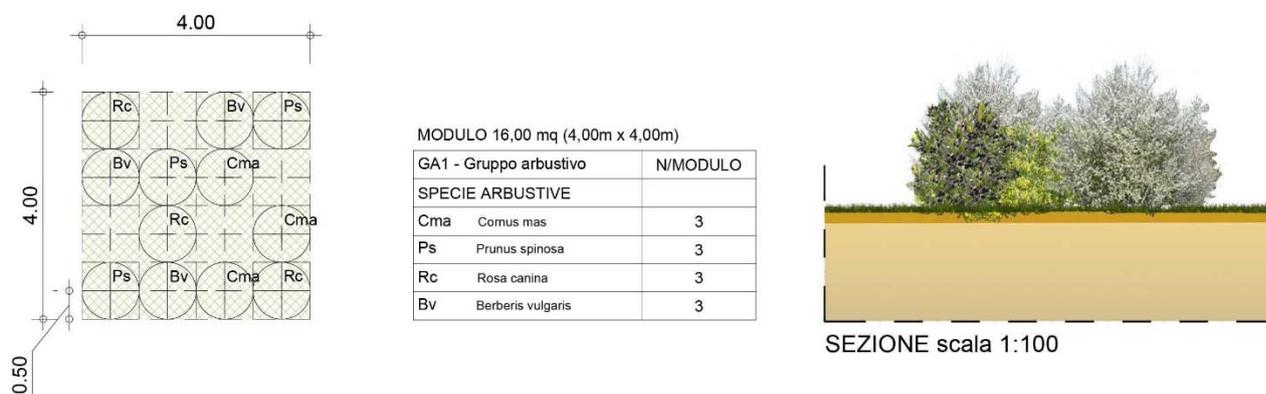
Pianta e sezione gruppo arbustivo tipo 1
